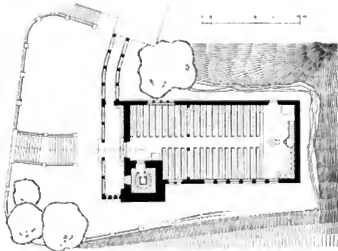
Grundriss der Kirche. — Masstab 1:400.
